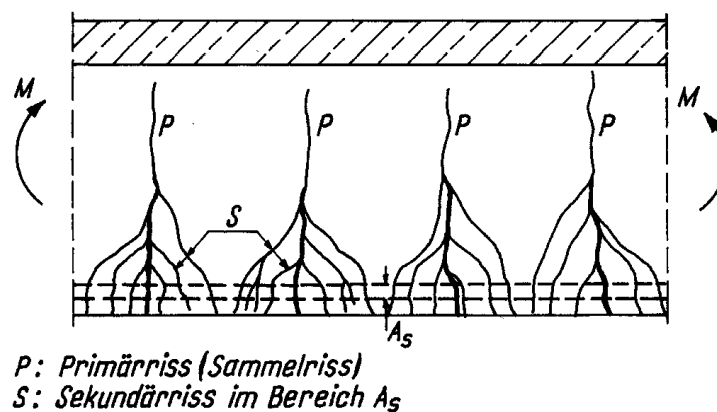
Rissbild eines hohen Balkens mit schwacher Stegbewehrung
